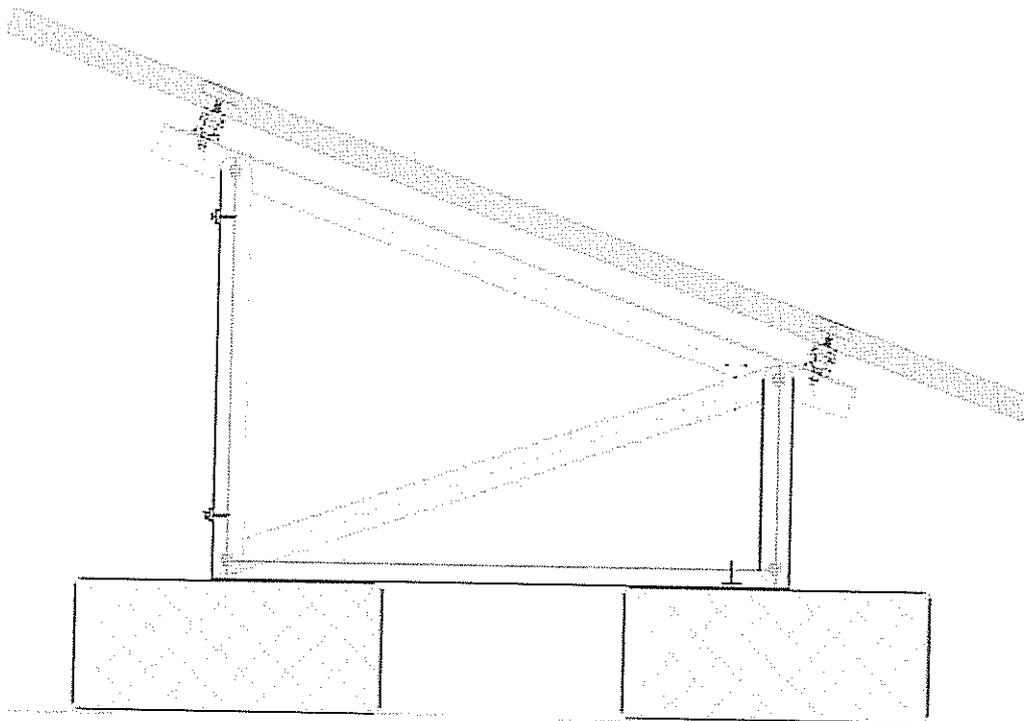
Vista laterale struttura di supporto in profili di alluminio: fissaggio indiretto con zavorra in cls.
